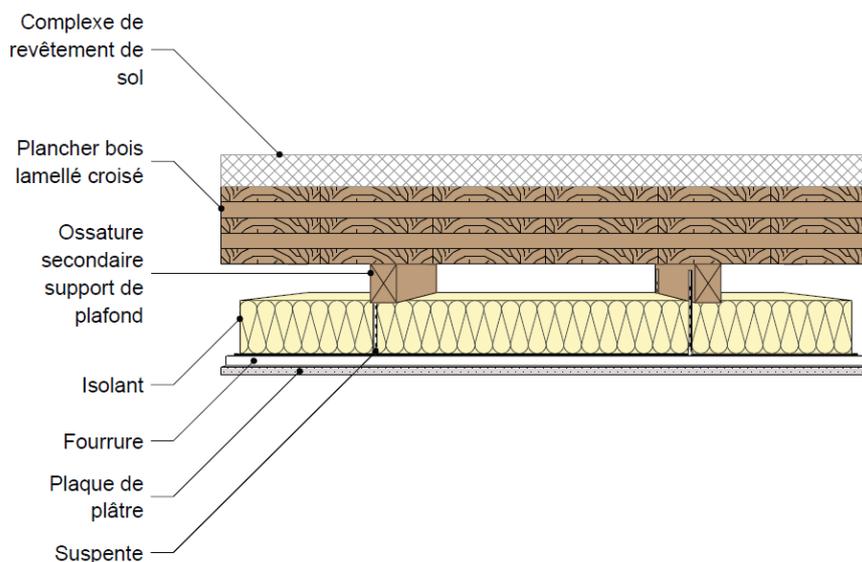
Plancher en panneau structural en bois contrecollé-croisé (CLT) selon Avis Technique / DTA
